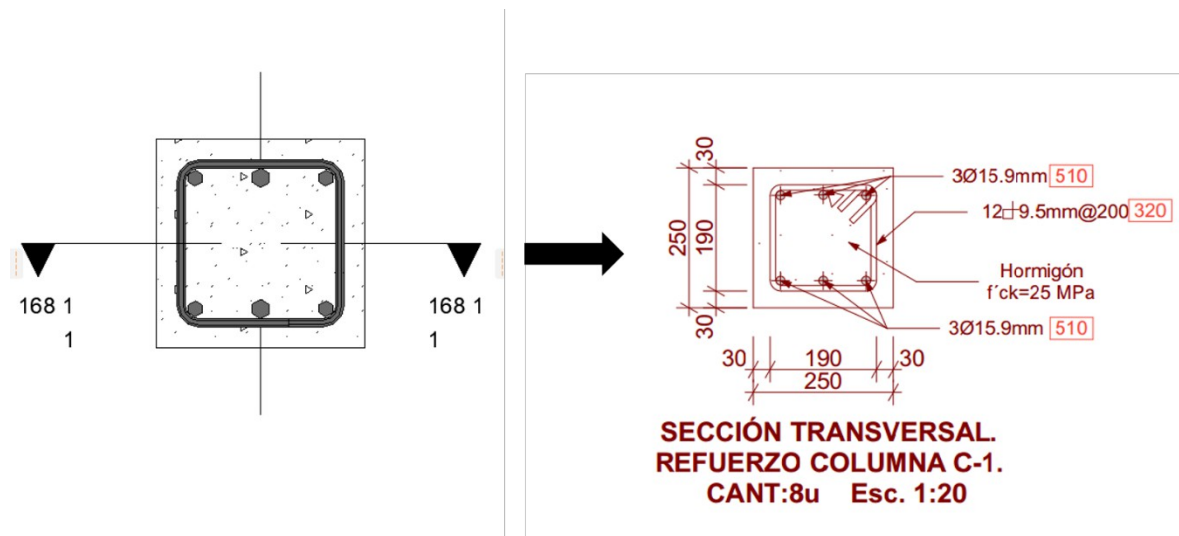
Vista de corte 1:1 y Sección transversal de la columna C-1 utilizando la información paramétrica del modelo
